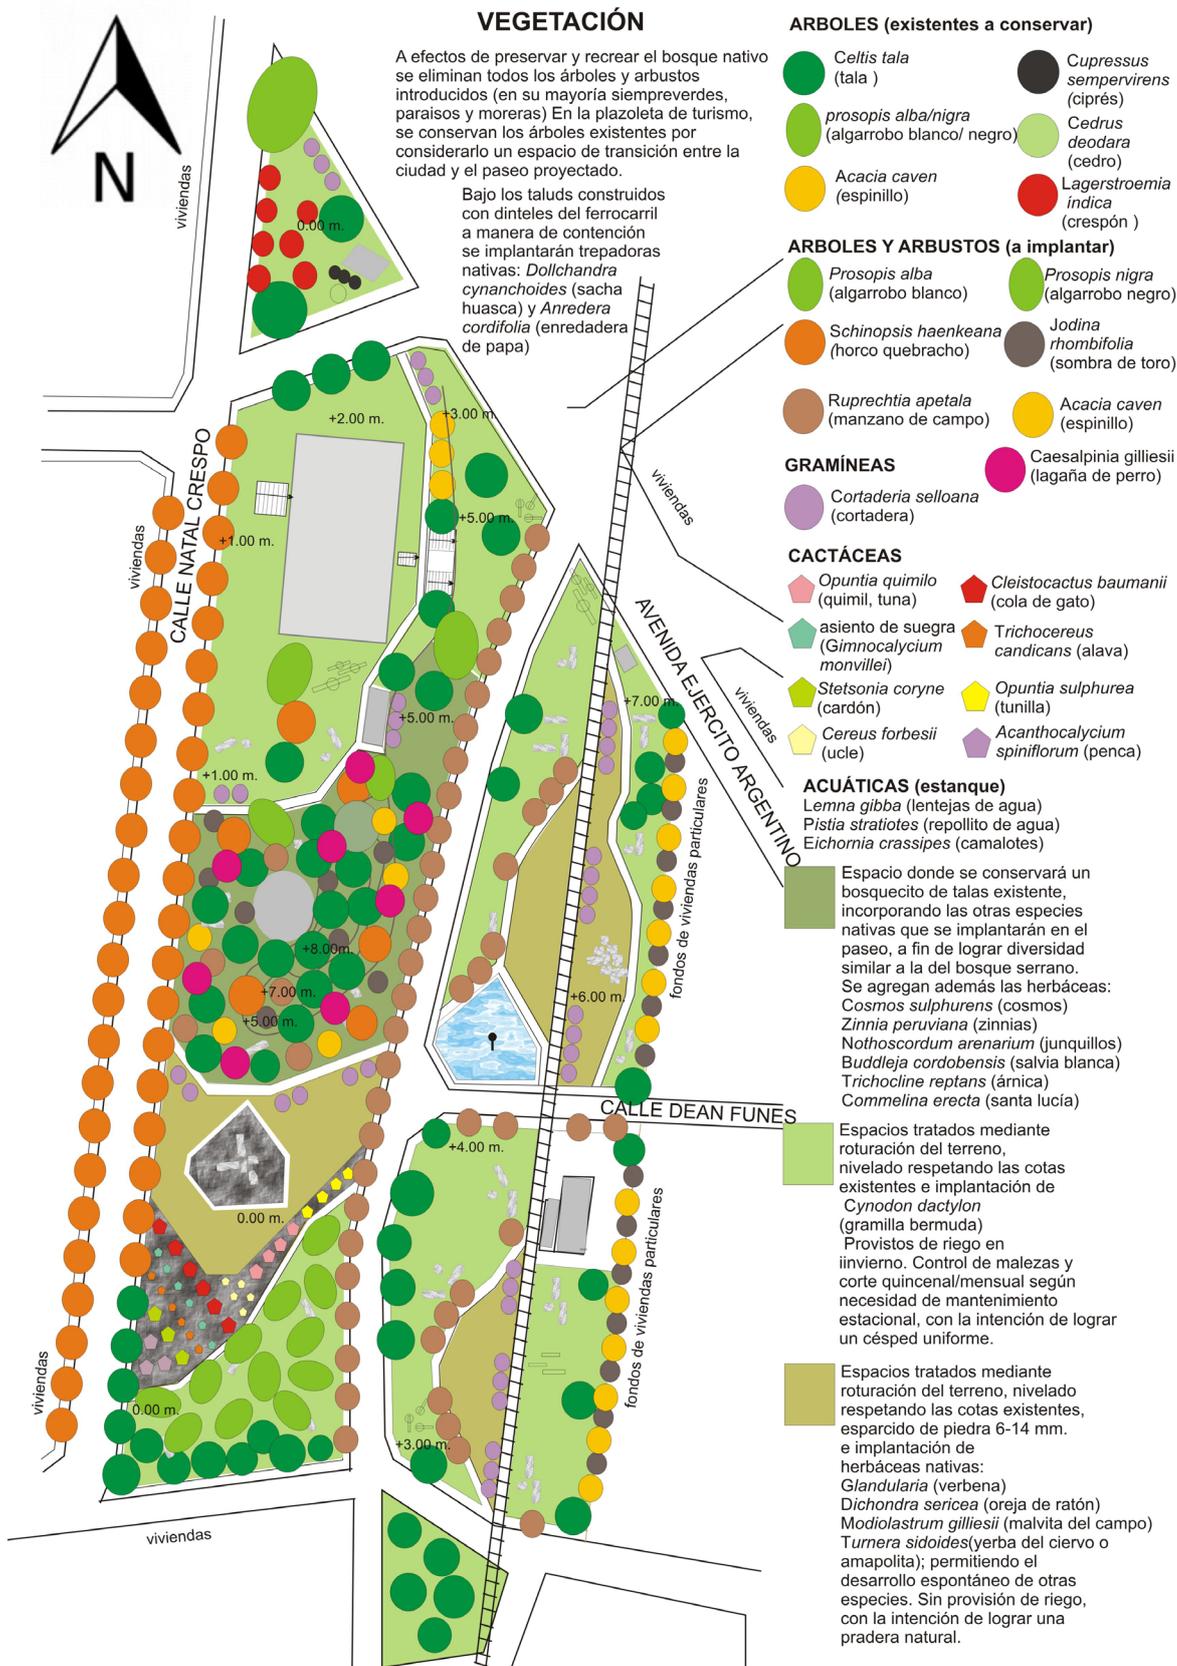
Planta de vegetación. Fuente: Elaboración propia.
